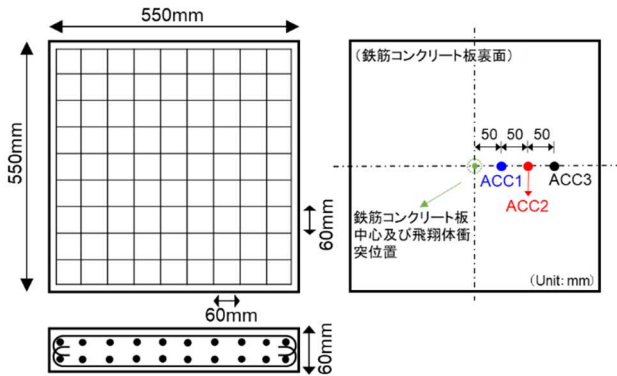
鉄筋コンクリート板（板厚 60mm）の概要
